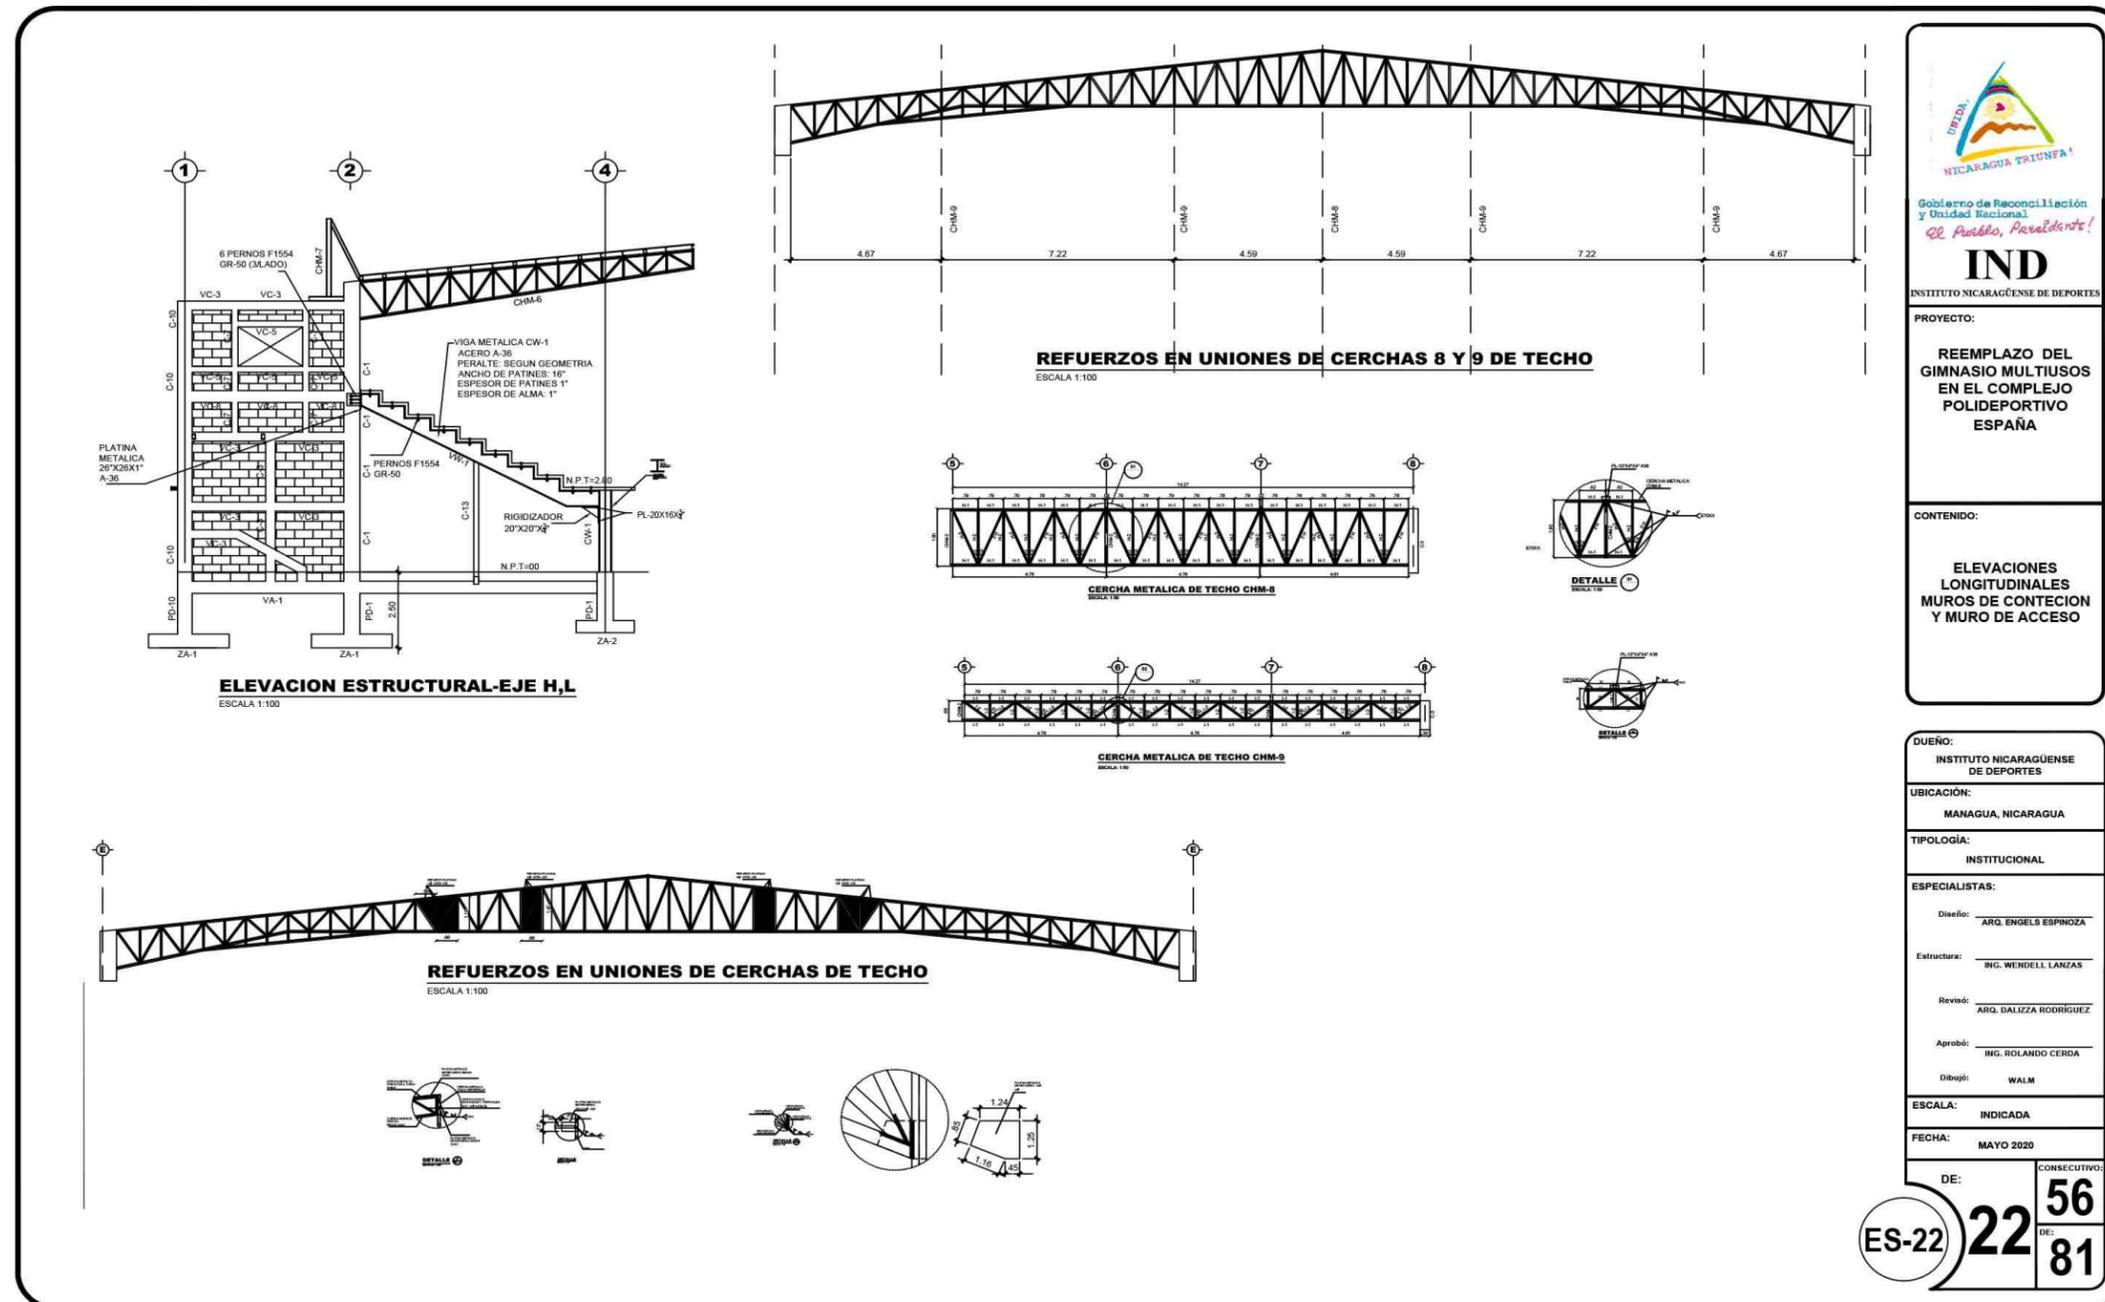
Plano Arquitectonico de colocacion de refuerzos en uniones de cerchas de techo, modificada y realizada por la Practicante
